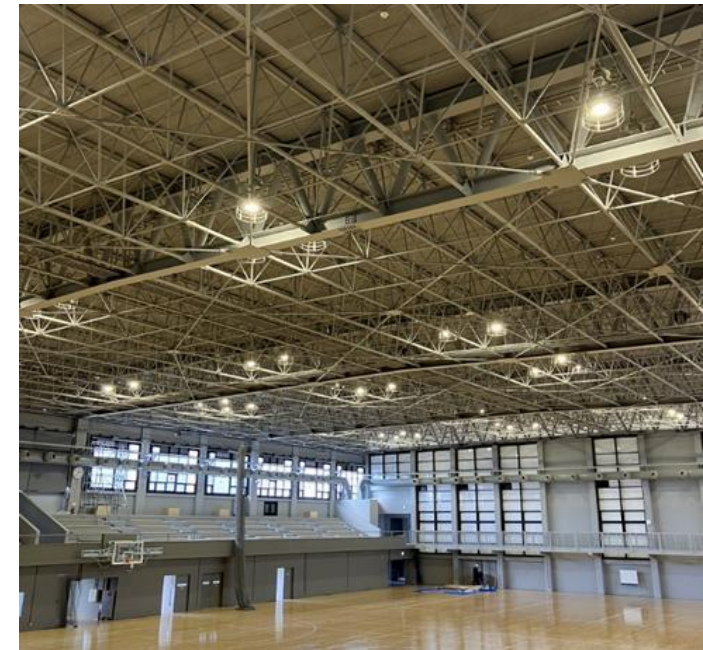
屋根面立体トラス補強後（補強水平ブレースあり）
